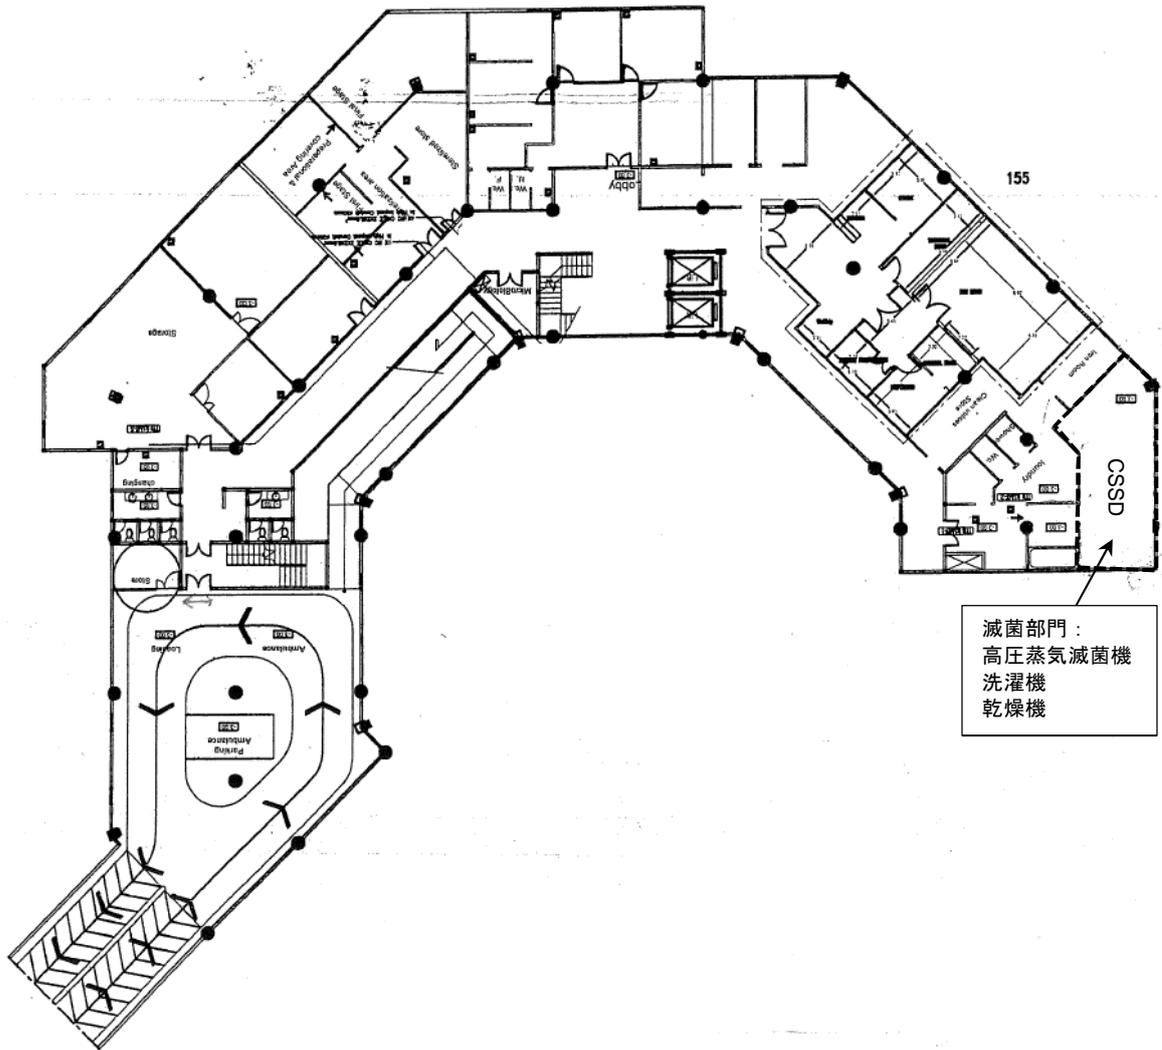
平面図・機材配置図（高圧蒸気滅菌機、地下階）
